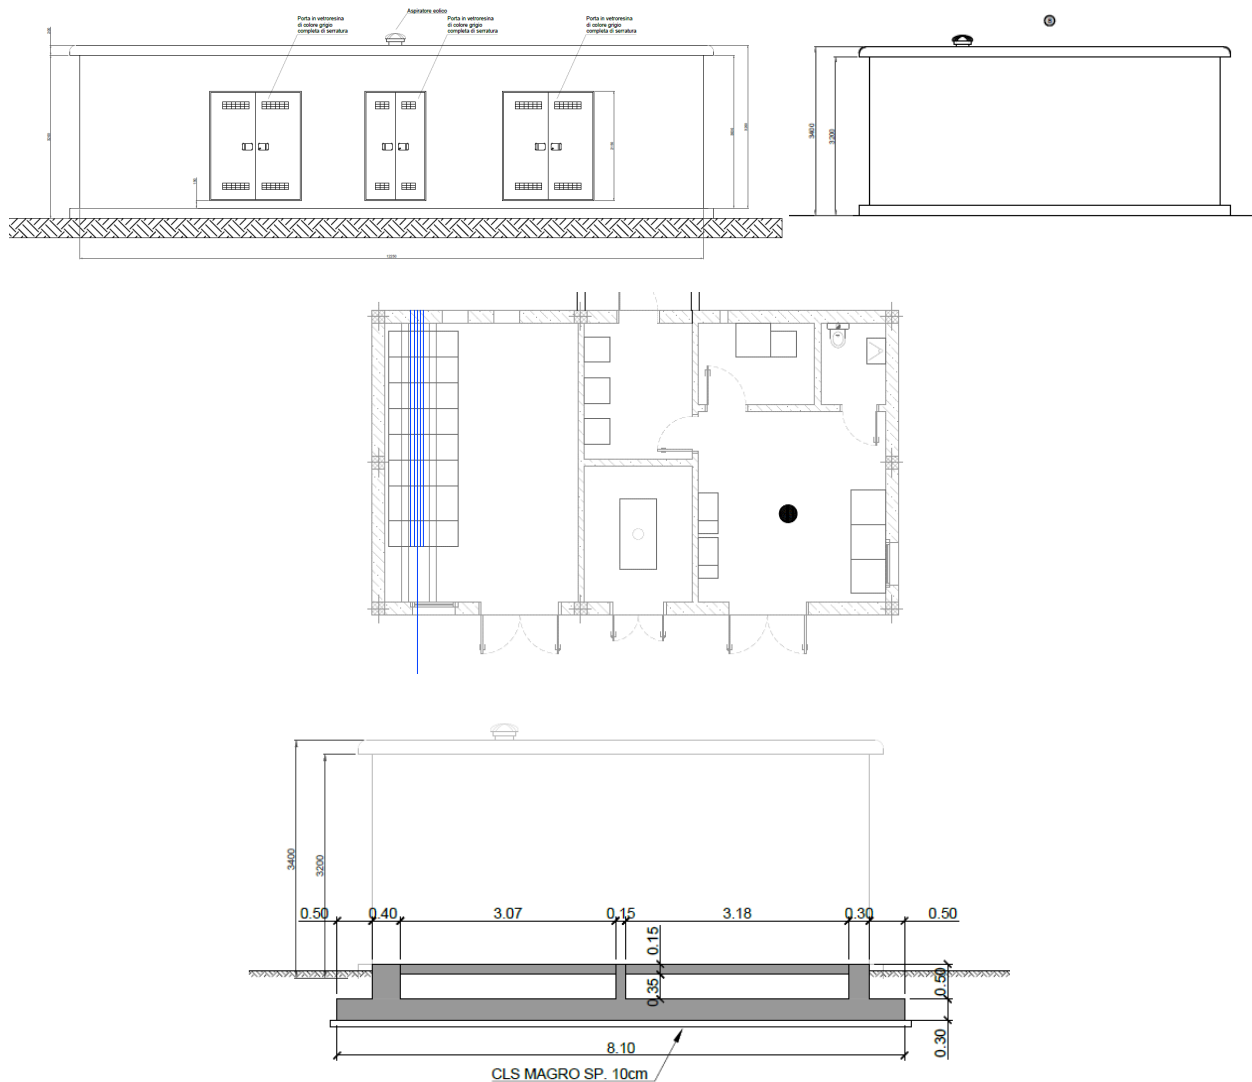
Prospetti, planimetria e sezione della cabina della sottostazione.
